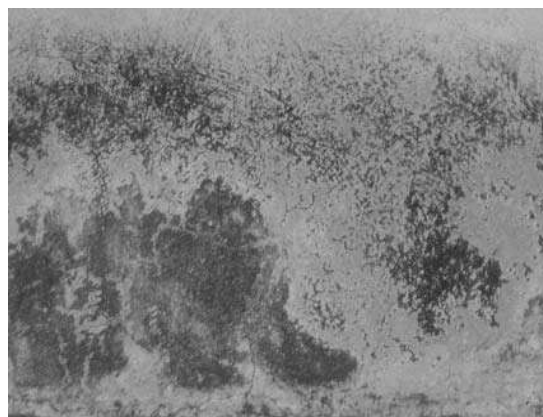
Costras negras en aplanado exterior de muro. MCHB. 23/12/14.
